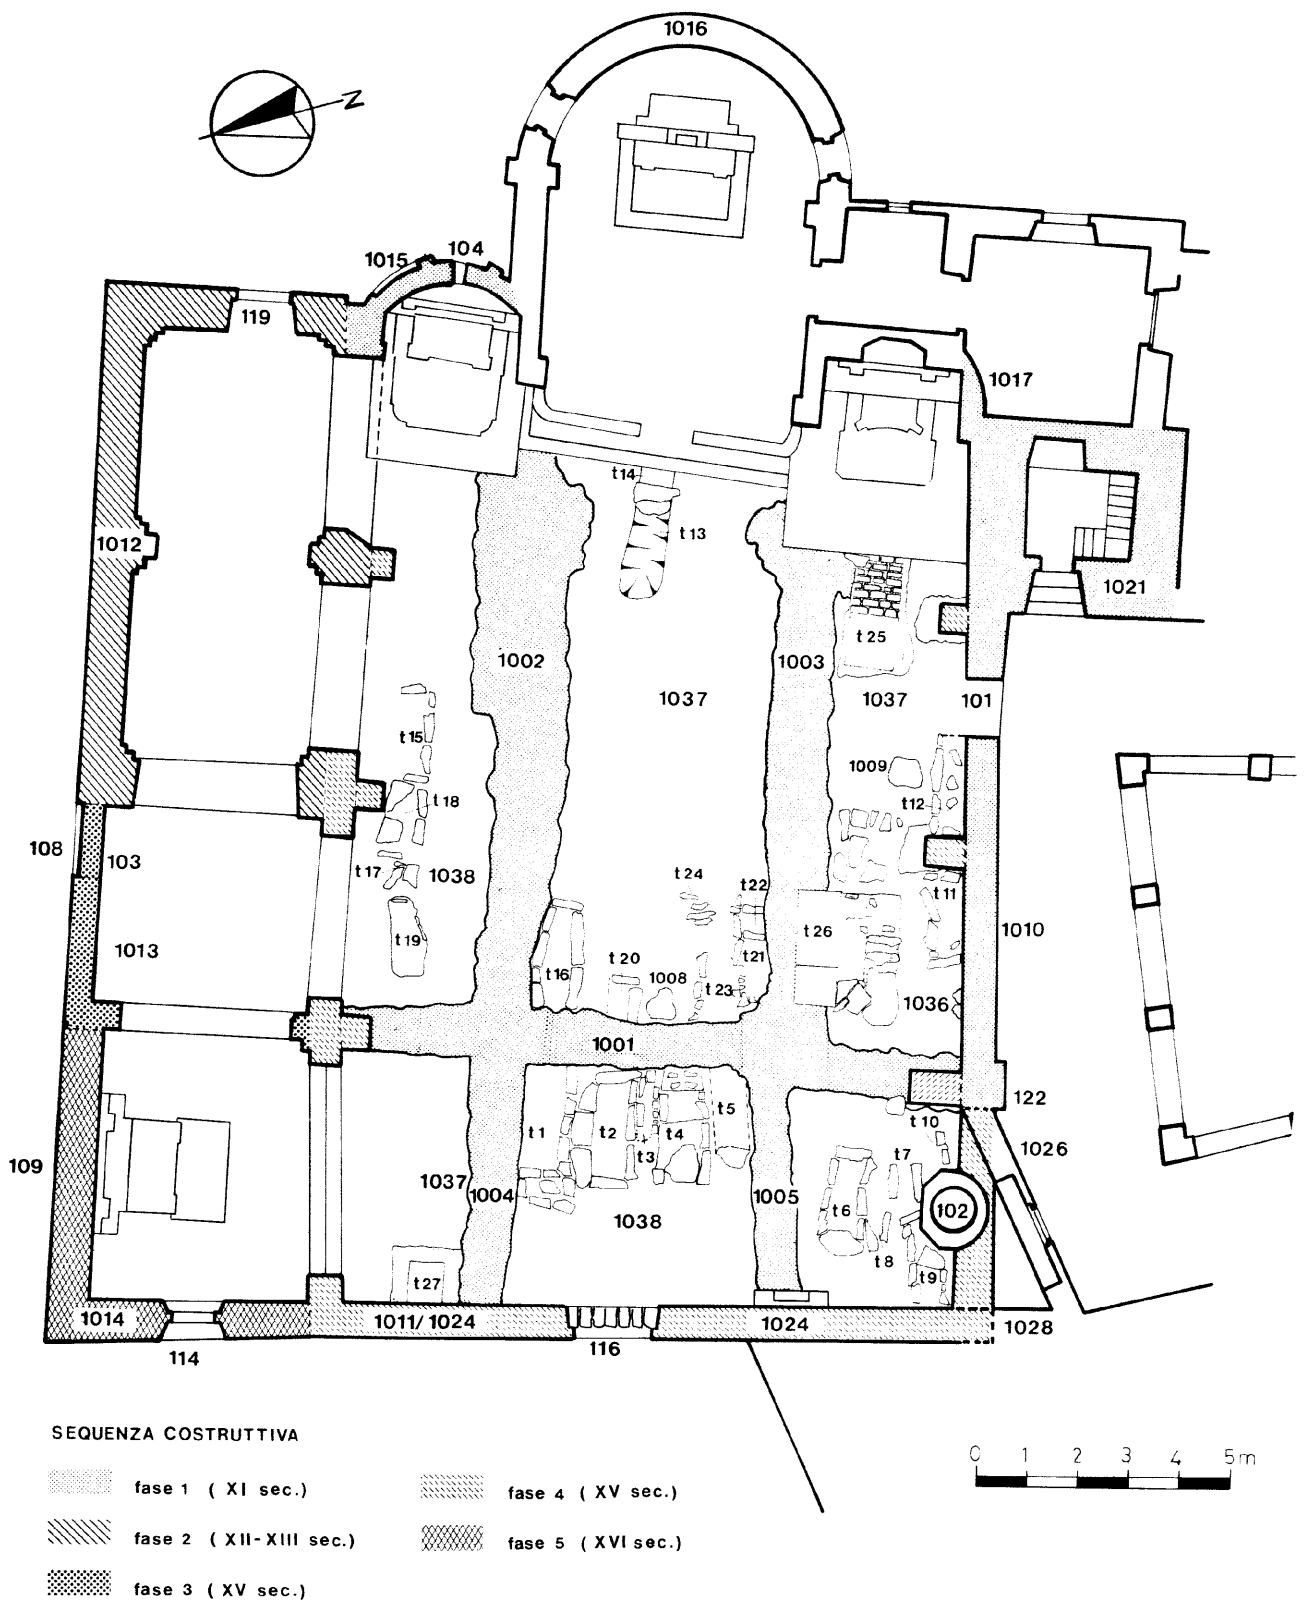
Planimetria generale della chiesa e delle strutture scavate
